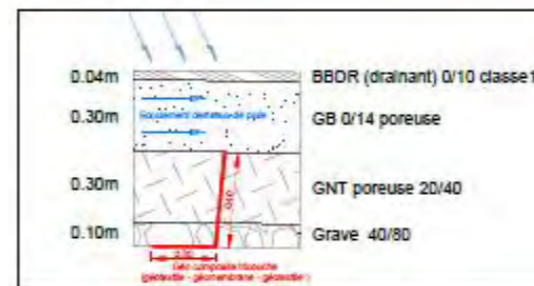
Plan principe d'assainissement (6/6) (source : AVP, 2024)
